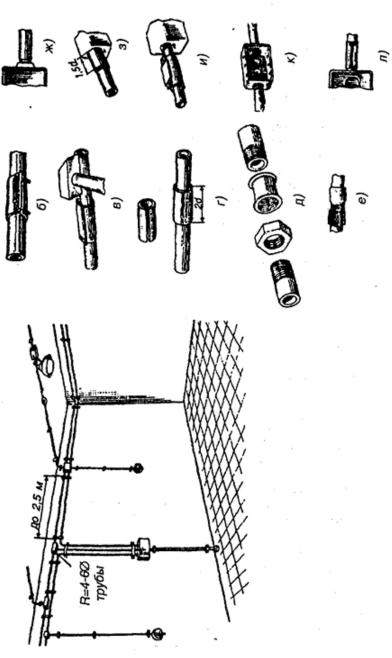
Монтаж электропроводок в стальных трубах:
